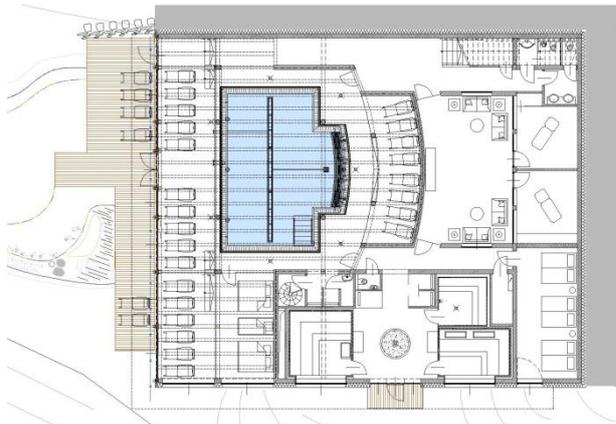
kompakter Grundriss – Zwiebelschalenprinzip – Belichtungsflächen ausschließlich nach Südwesten und Südosten, NW und NO Fassade vollständig erdberührend
